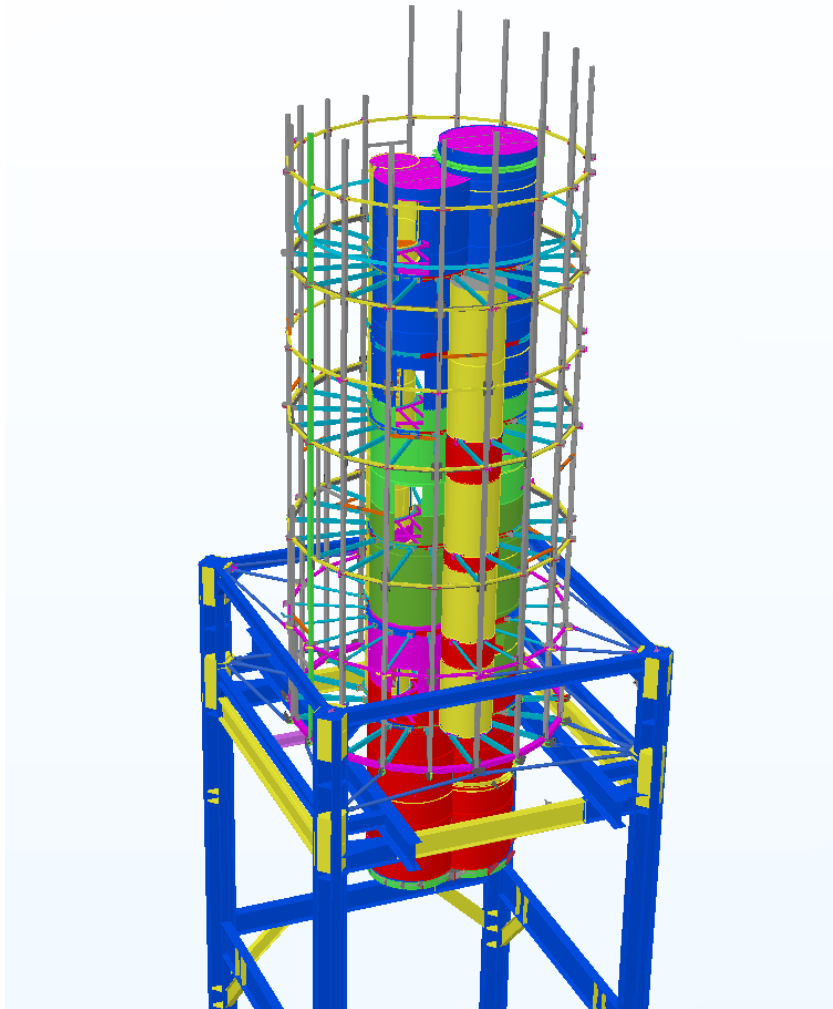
Detail začepování ocelových táhel do styčnicků stávající konstrukce (BIM sight)
